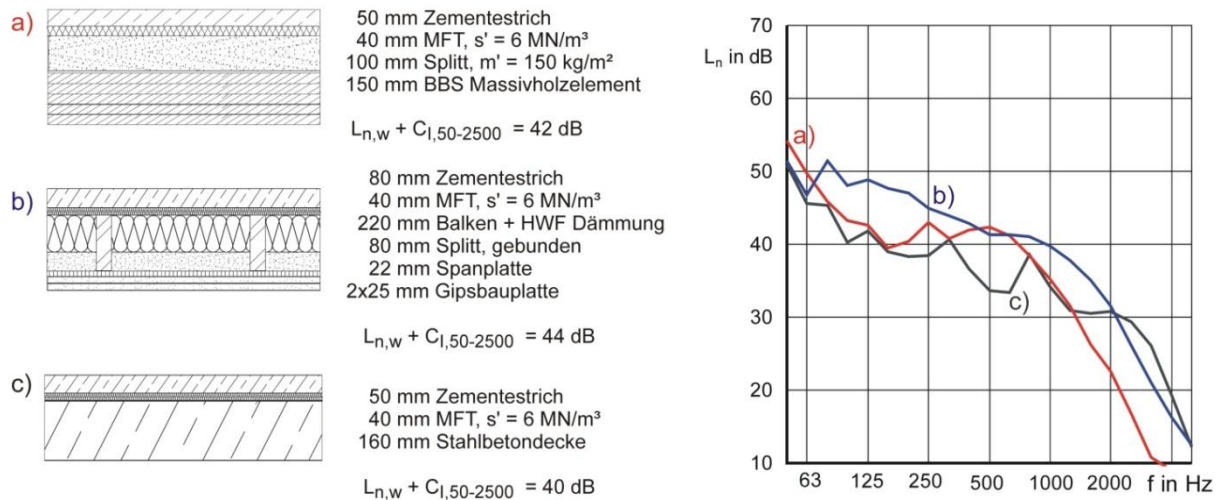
Messwerte optimierter Holzdecken durch Erhöhung der Masse im Vergleich zu Stahlbetondecken [14]
